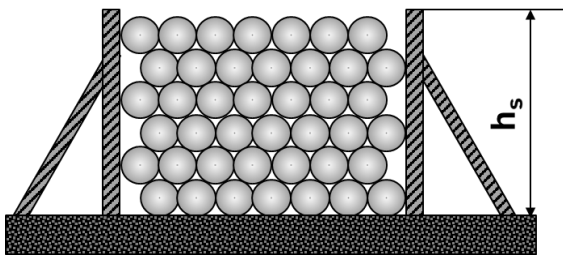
Hauteur d'empilement des tubes de protection de câbles
